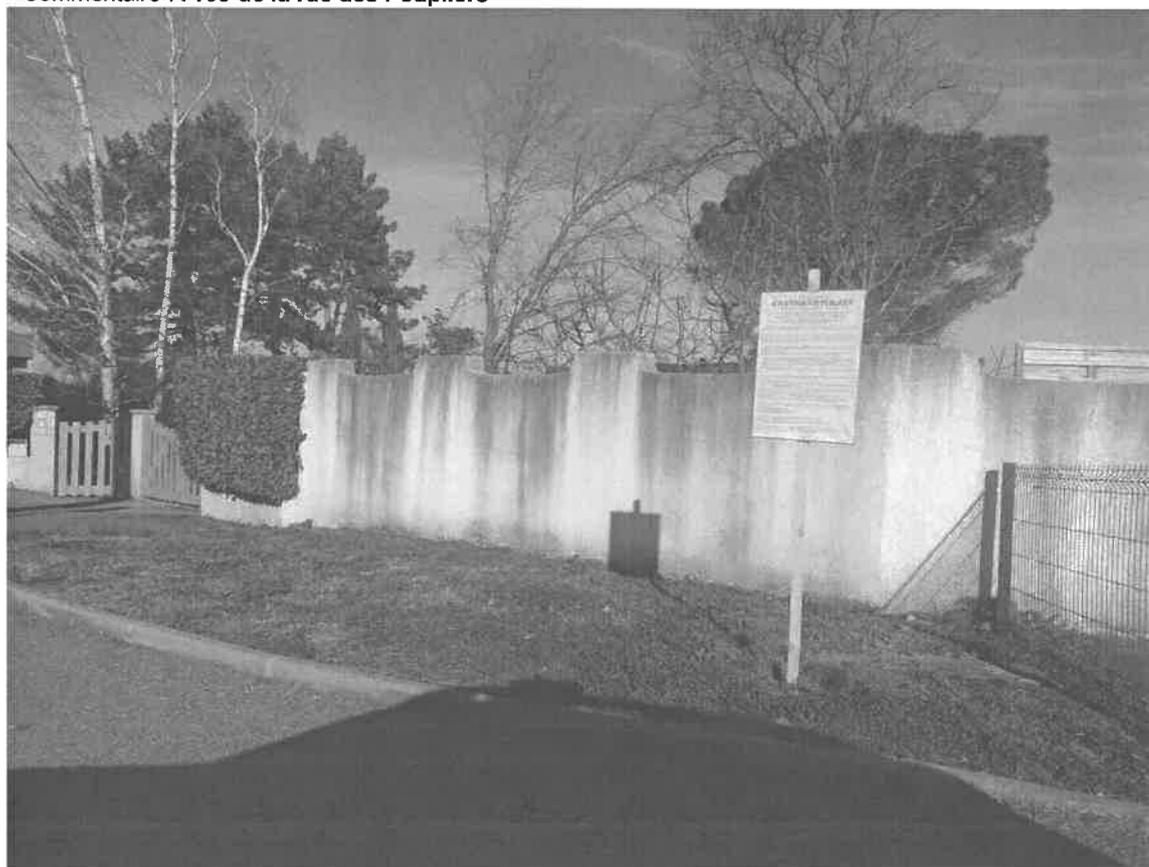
RUE DE COUTHOL - 14 FEVRIER 2024
